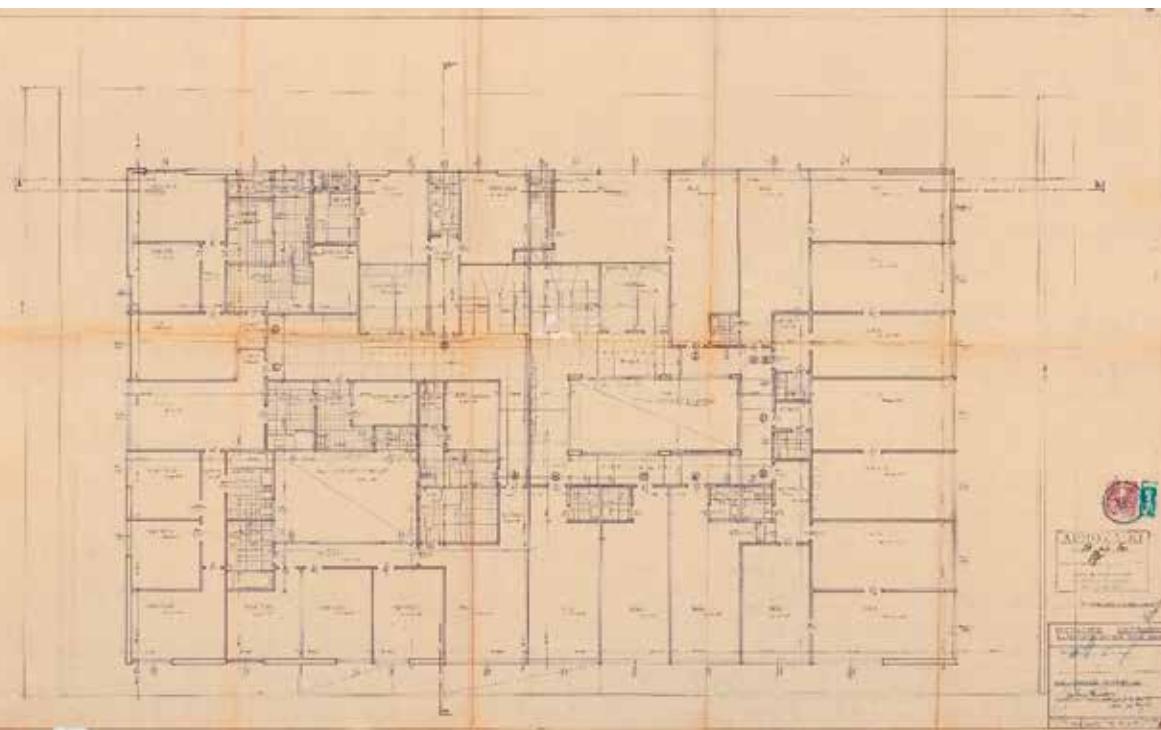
Planta baixa do terceiro pavimento do Edifício Manchester
